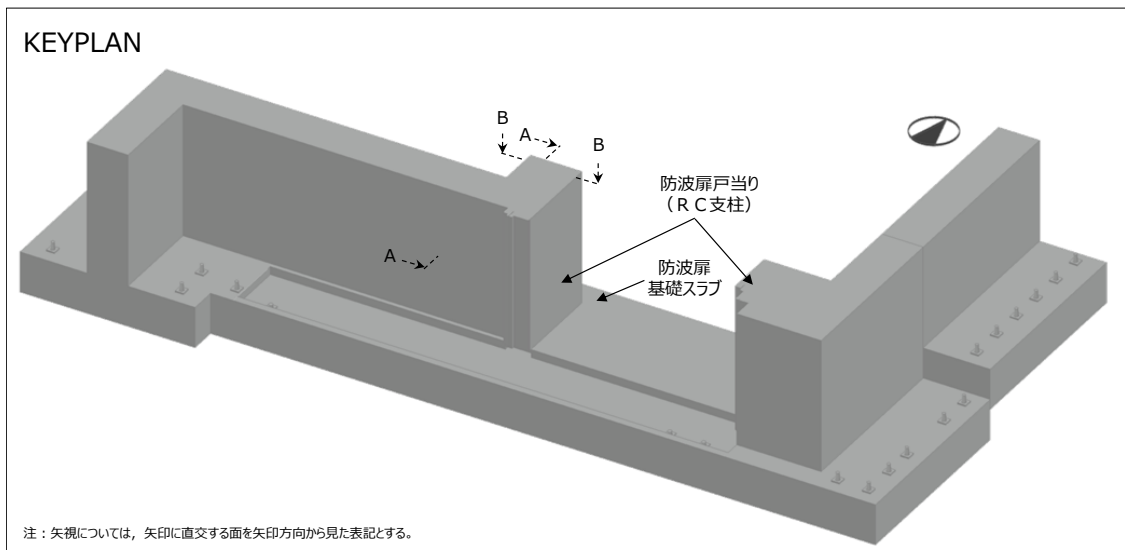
(1) 防波扉戸当り (RC支柱) 及び基礎スラブの概略配筋図
